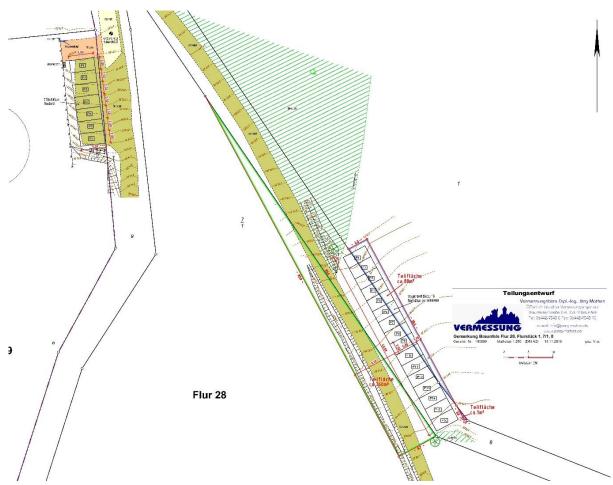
Lageplan mit den eingemessenen Stellplätzen am Hochbehälter und Lage der Wege (dunkelgrün dargestellt) sowie Eintrag der ursprünglich vorgesehenen geplanten zusätzlichen Stellplätze (Vermessungsbüro Mathes, Nov, 2019)
